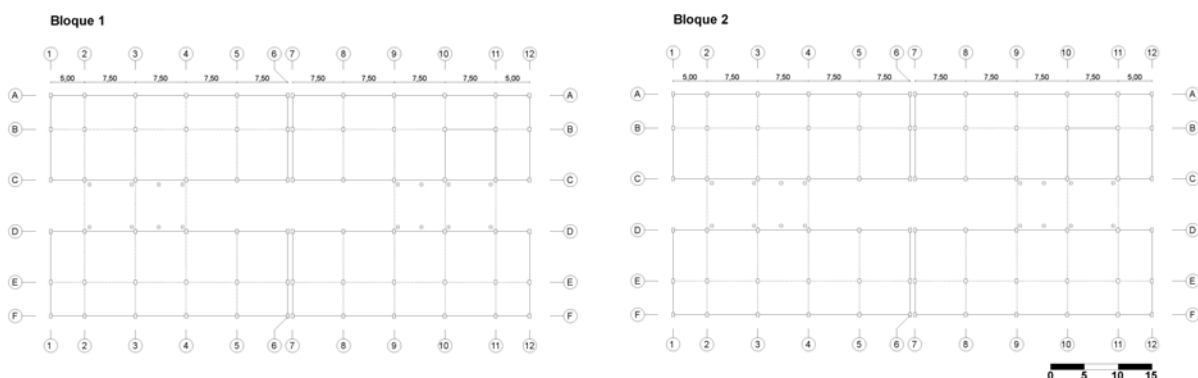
Ejes y distribución estructural Bloque 1 y Bloque 2
